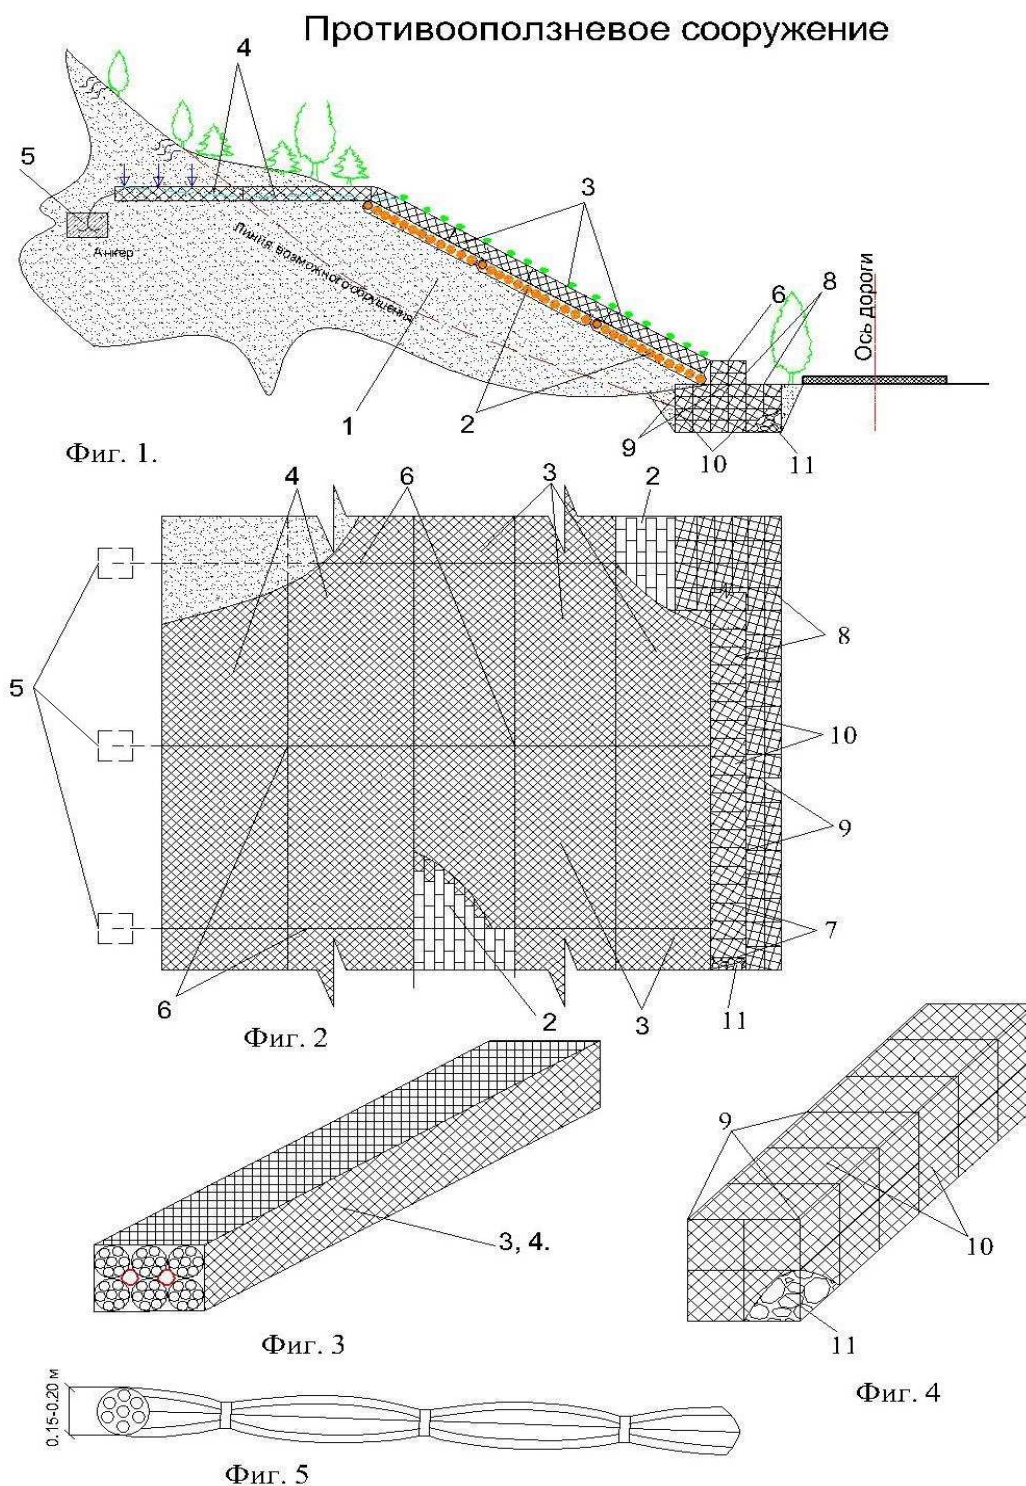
Противооползневое сооружение содержит грунтовой массив 1, гибкие тюфяки 2, изготовленные из легких фашин, габионные тюфяки 3 и 4, бетонные анкерные устройства 5 с соединительными и крепежными арматурными проволоками 6 из нержавеющей стали, дренажная ступенчатая призма 7, устроенная из армированных габионов 8. При этом армированный габион 8 выполнен из арматурного каркаса 9, оцинкованной металлической (габионной) сетки 10 и каменного заполнителя 11.
